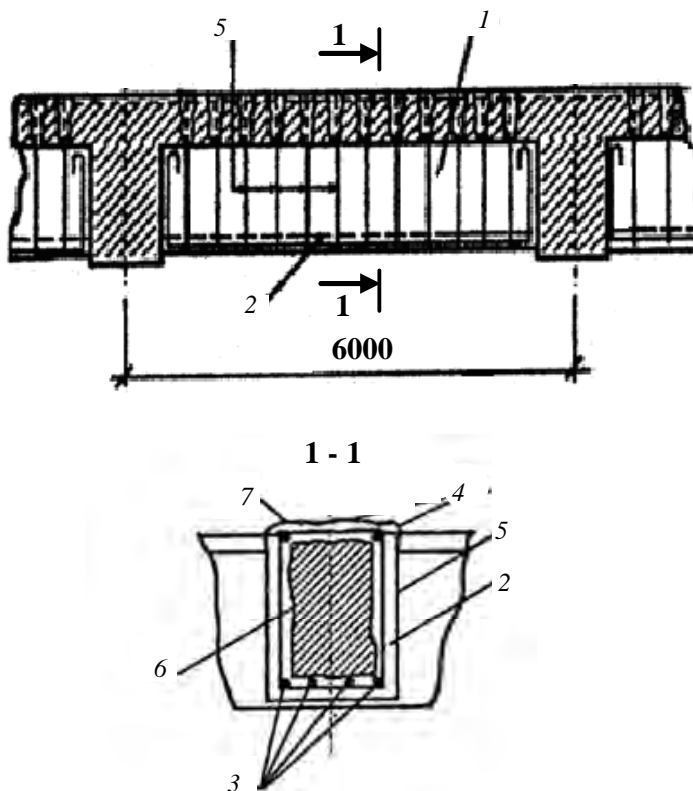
Усиление монолитной балки железобетонной рубашкой:
